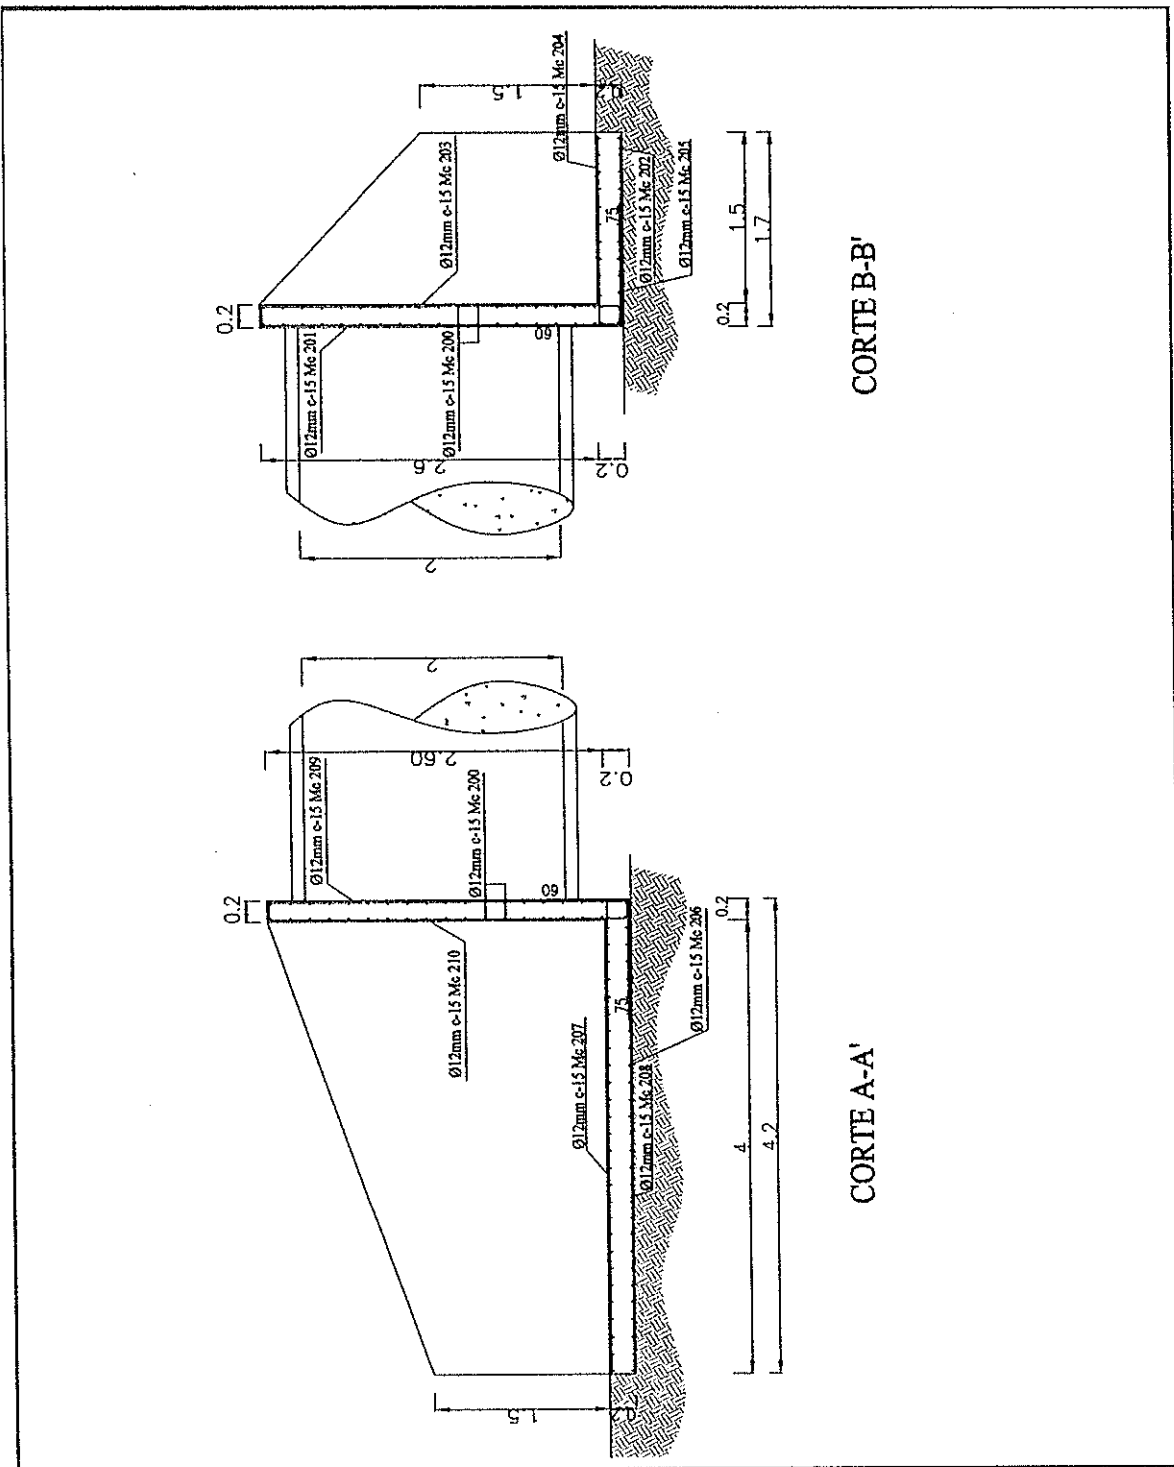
DETALLE MURO DE ALA ALCANTARILLA No. 1
